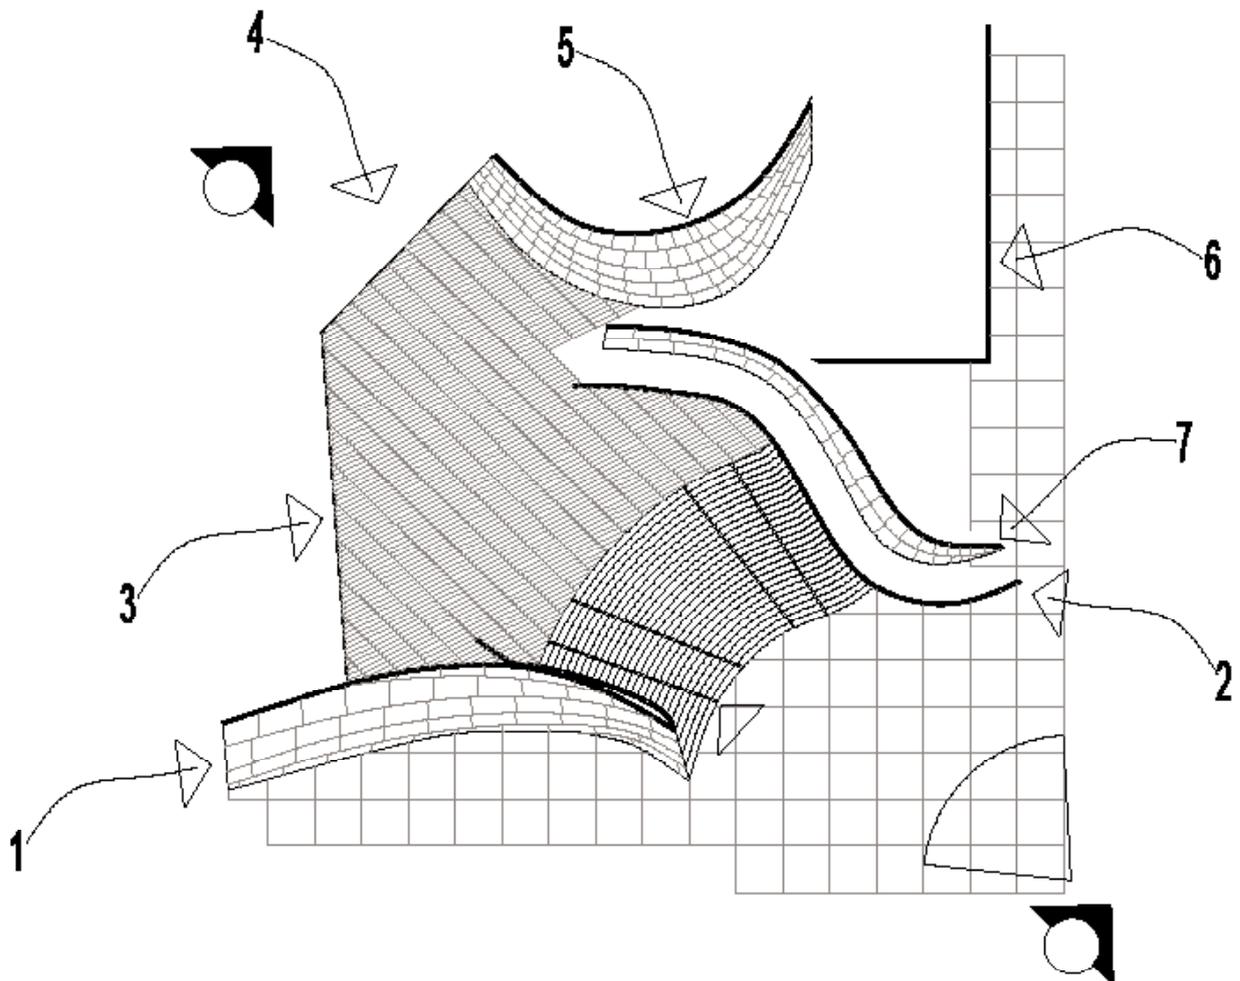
Planta da proposta de divisão e numeração do elemento cénico em partes, desenho do autor
